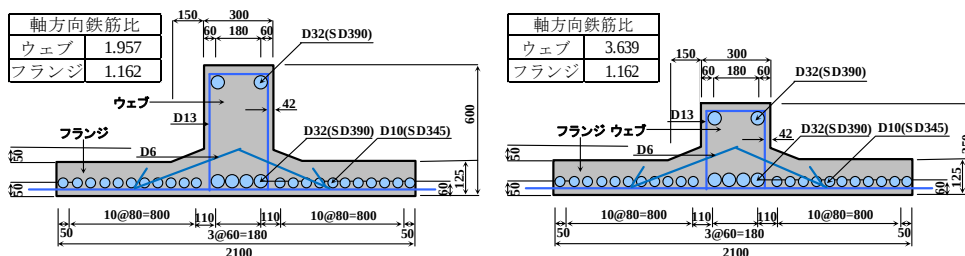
試験体諸元(左：試験体 No.2, 右：試験体 No.3)
